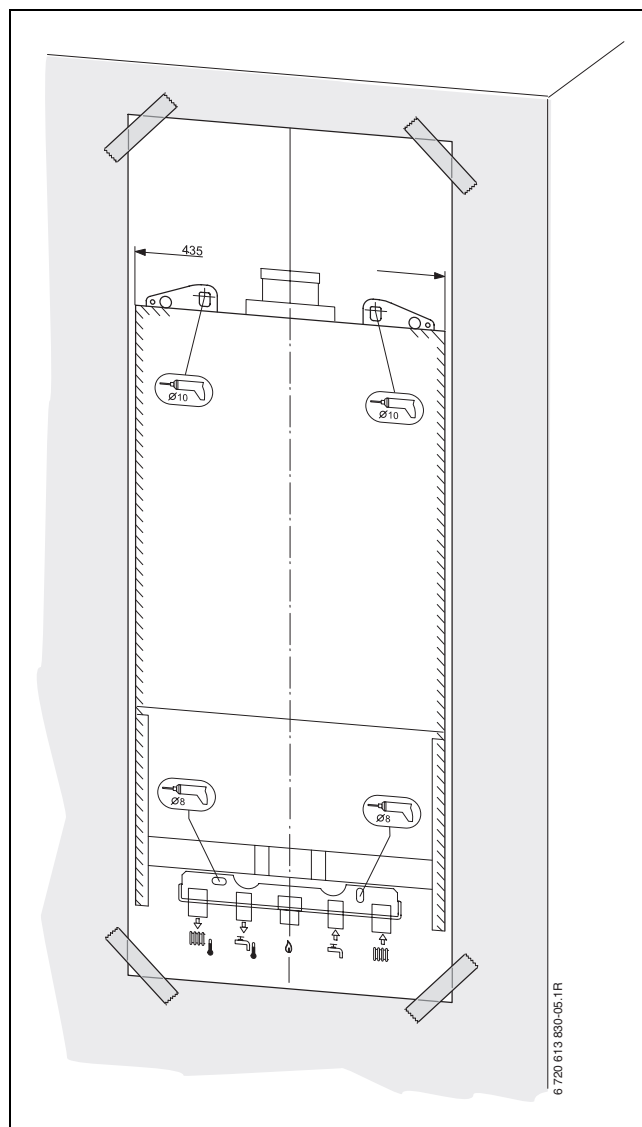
Stampato per il montaggio (esempio piastra di collegamento per il montaggio verticale)
